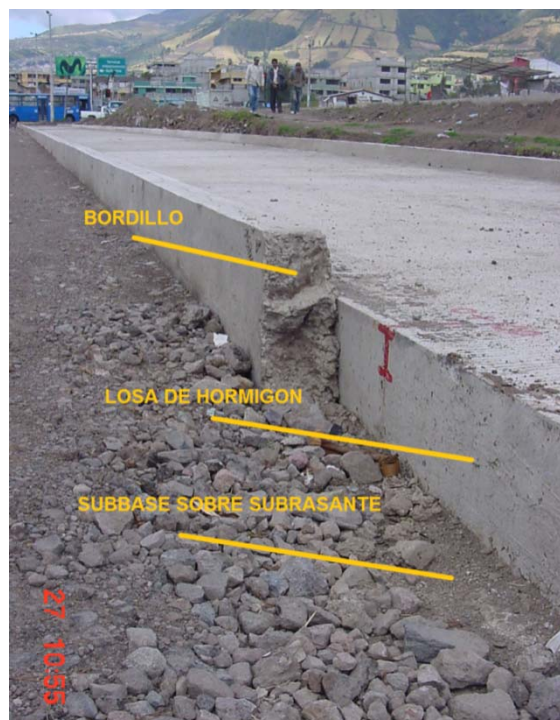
Estructura de un Pavimento Rígido, cerca de la Terminal Quitumbe
